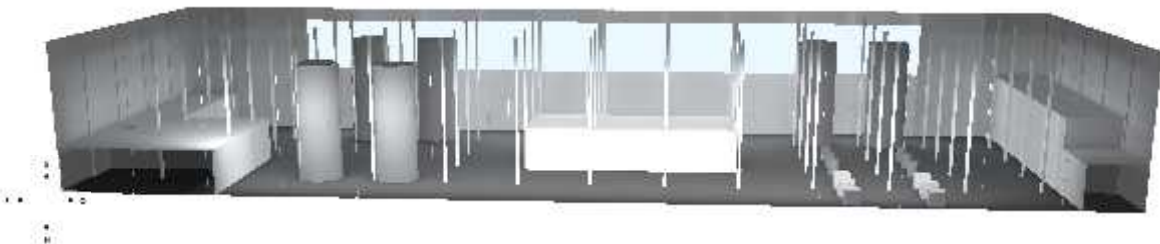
Vista en 3D del ventanal en fachada Sur, propuesta 3.
